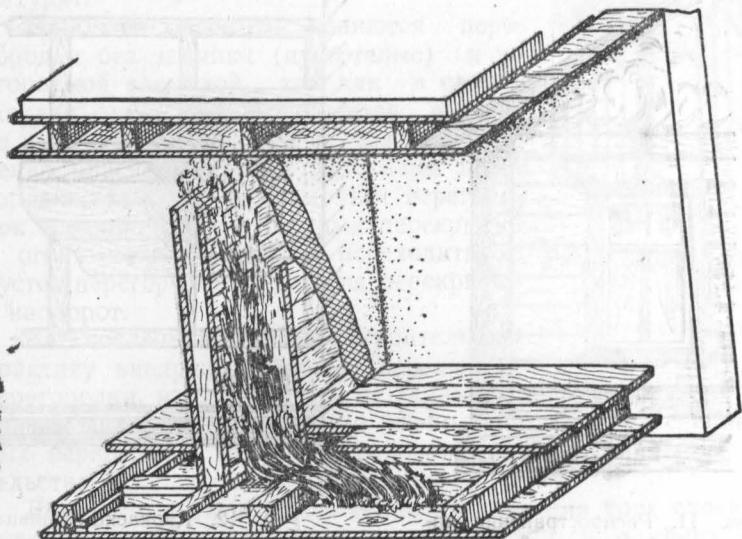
Распространение пожара по пустотам перекрытий и перегородок.
